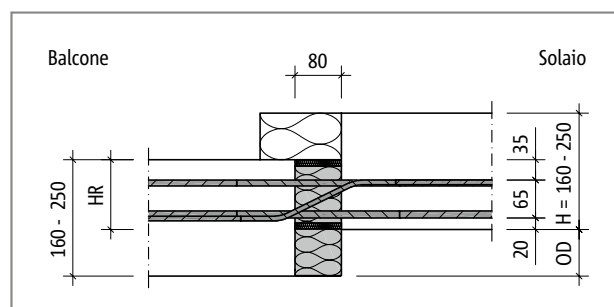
Schöck Isokorb® T tipo K-UD: sezione dell'elemento
